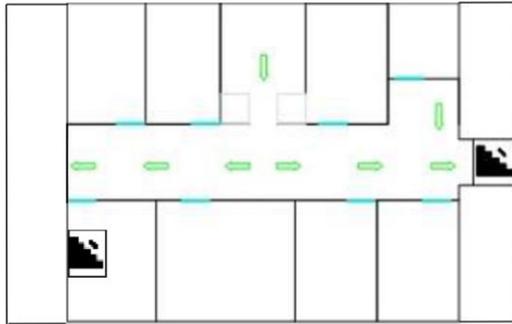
Denah Jalur Evakuasi Lantai Basemen
